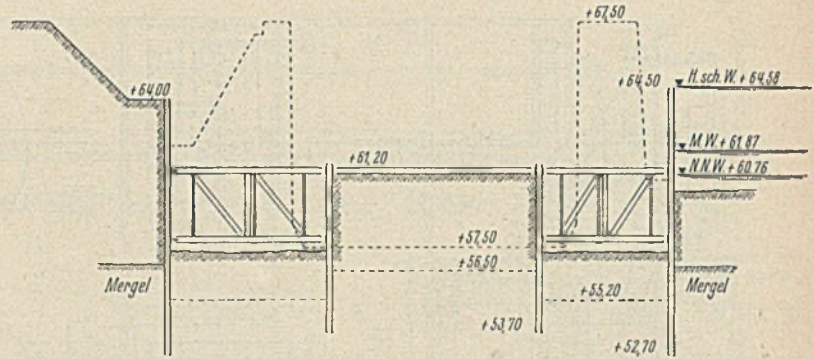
Aussteifung der Baugrube der Kammermauern. Querschnitt.
